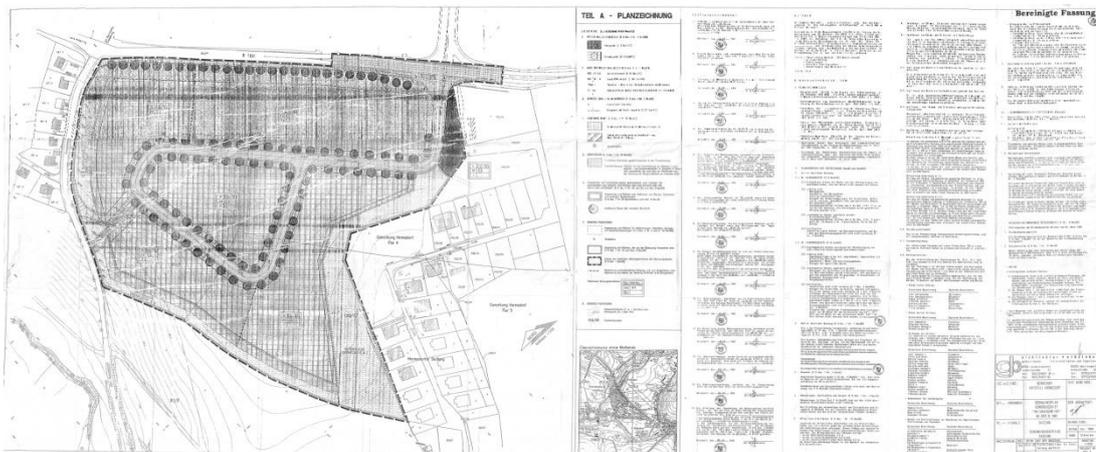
rechtskräftiger Bebauungsplan Gewerbegebiet „Am Sachsenring“
